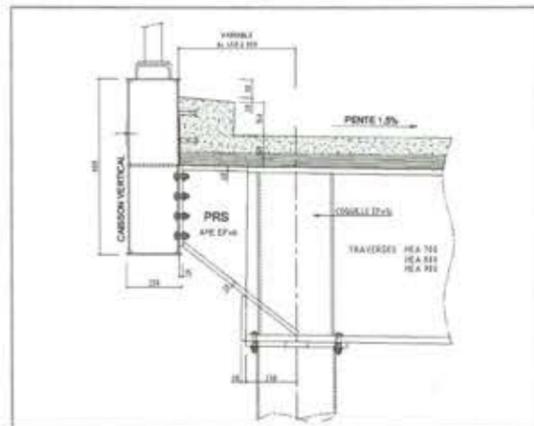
Coupe sur la rive de dalle / Edge detailed
